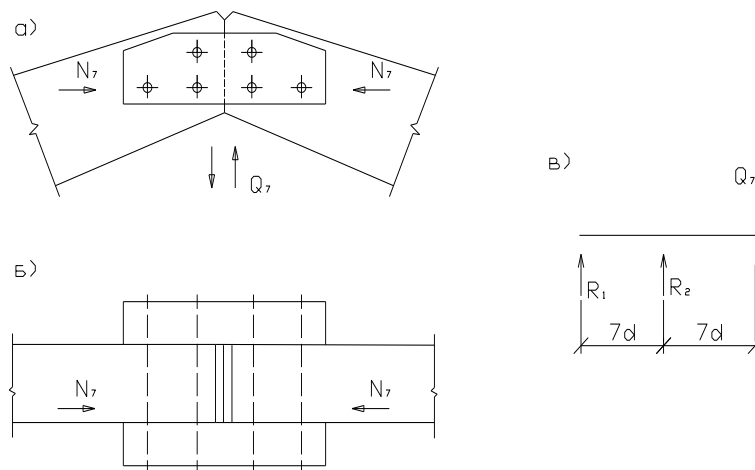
Схема крепления конькового узла: а) вид сбоку, б) вид сверху, в) схема левой стороны накладки для расчета болтов.
